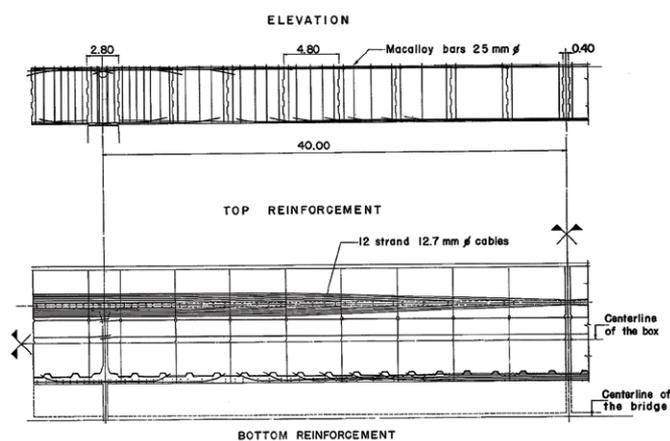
CABLAGEM REPROJETADA PARA A LAJE SUPERIOR DE 22CM CONCRETADA DE UMA SÓ VEZ
